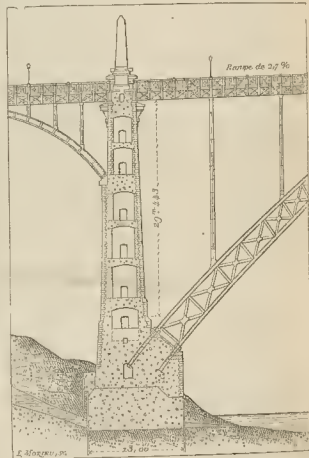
Sección longitudinal de una de las pilas del puente de Kornhaus
